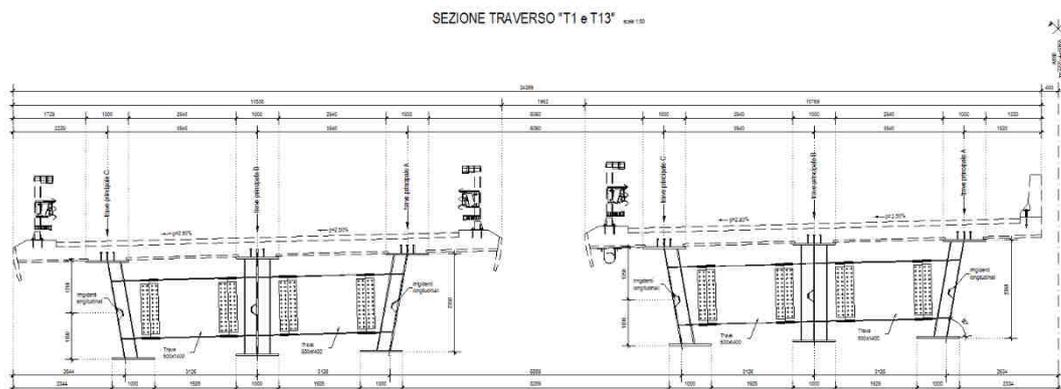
Sezione trasversale con traversi di testata – Cavalcavia svincolo SS.131dir
